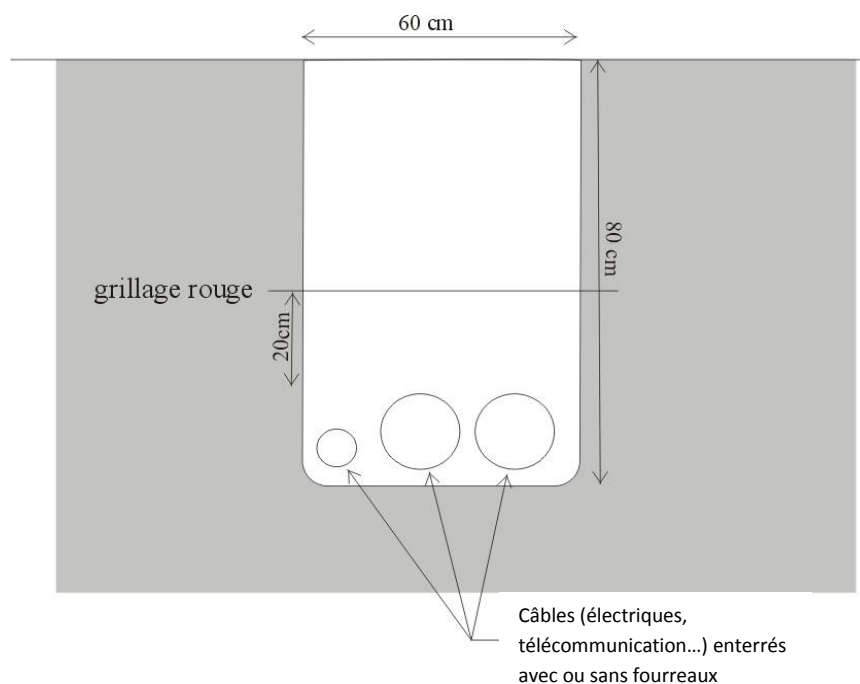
coupe d'une tranchée standard pour l'enterrement des câbles électriques
